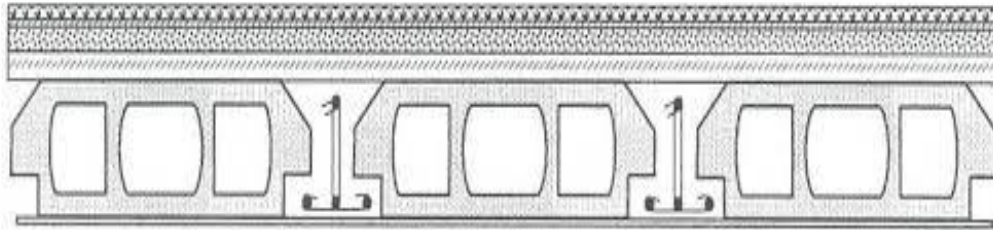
Coupe longitudinale d'un plancher à corps creux type (16+4)
